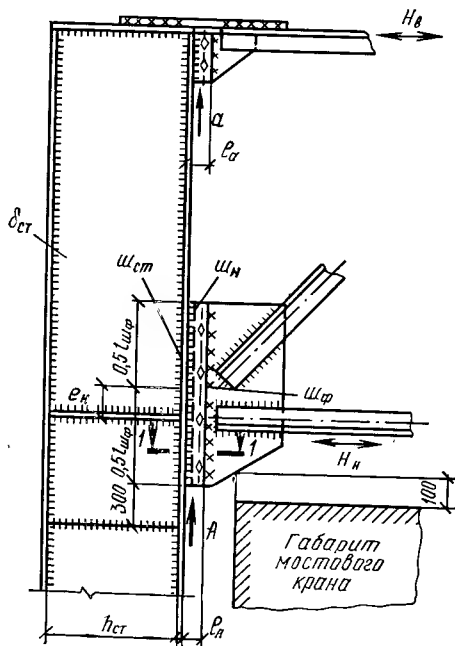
Жесткое сопряжение фермы с колонной крайнего ряда
